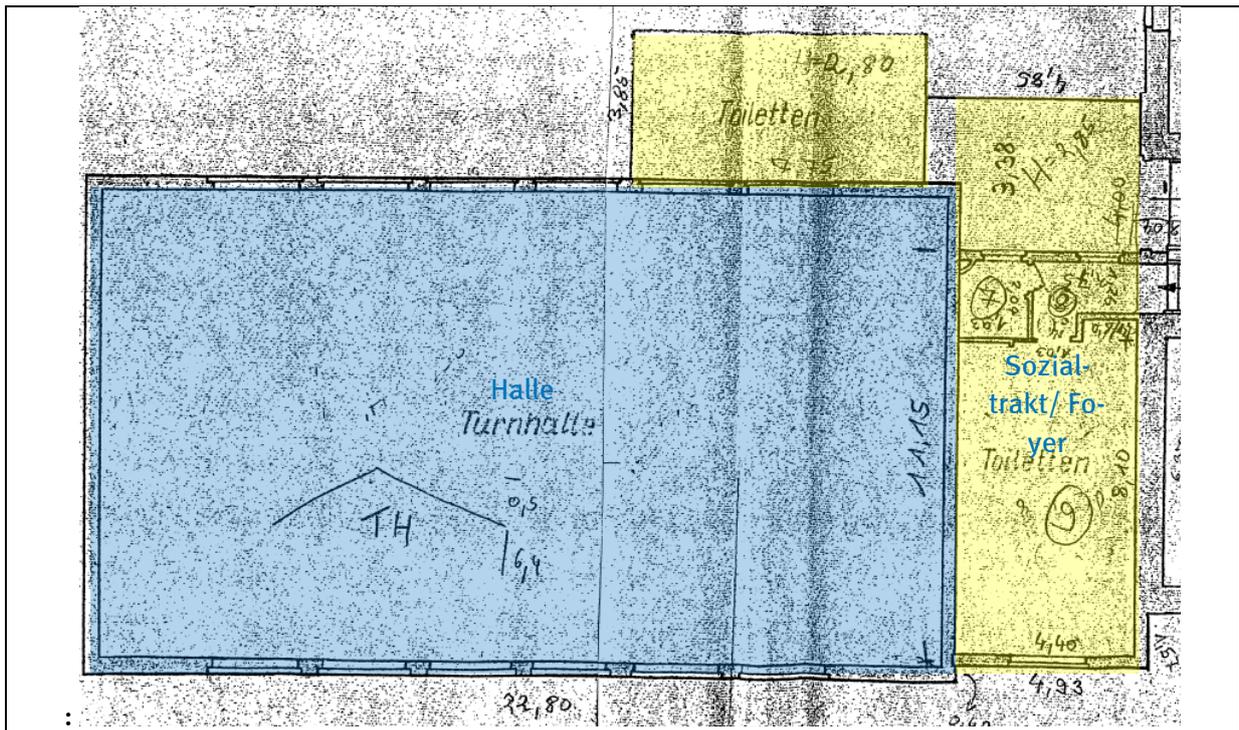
Grundriss/ Skizze TH 10 -(Quelle: ZGM)
